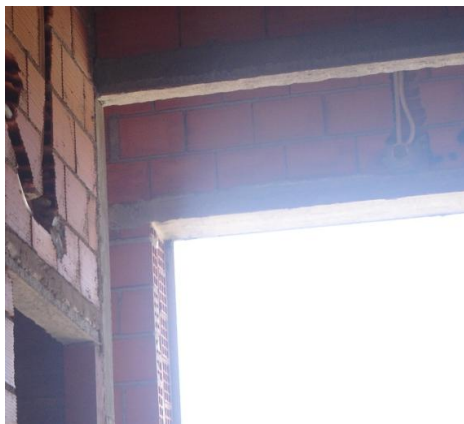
Pormenor da abertura para os envidraçados, Almeida
